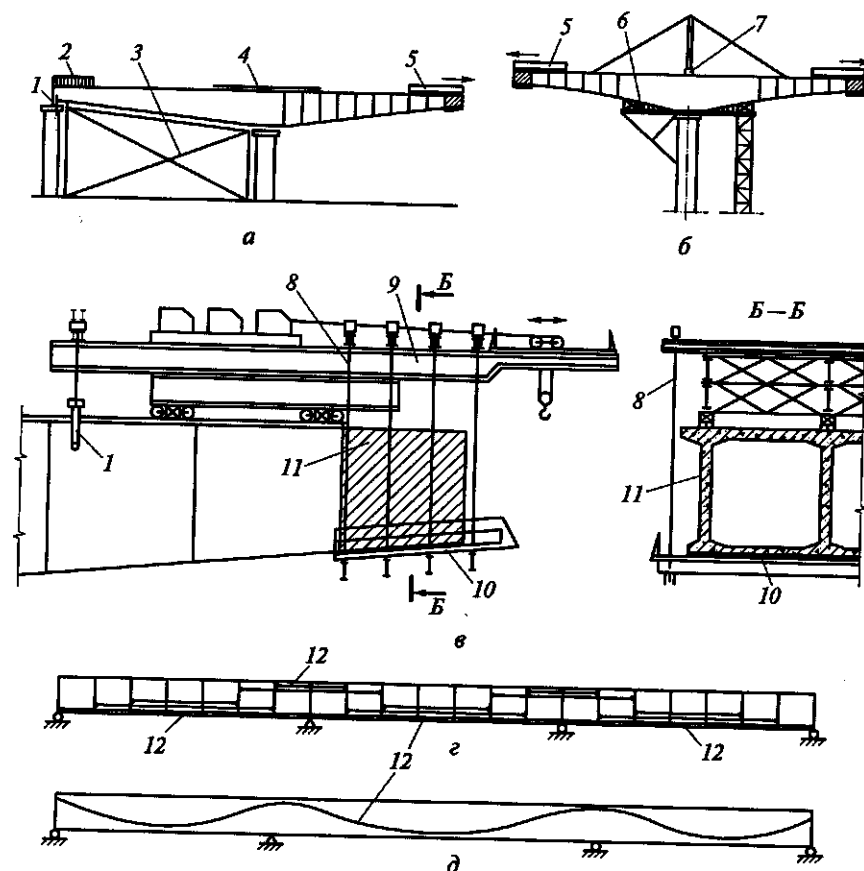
Возведение пролетных строений методом навесного бетонирования:
